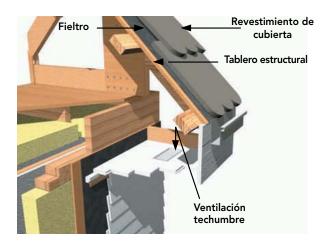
B: Sobre el tablero estructural se instala la barrera de humedad (fieltro) y sobre éste la solución de revestimiento.
